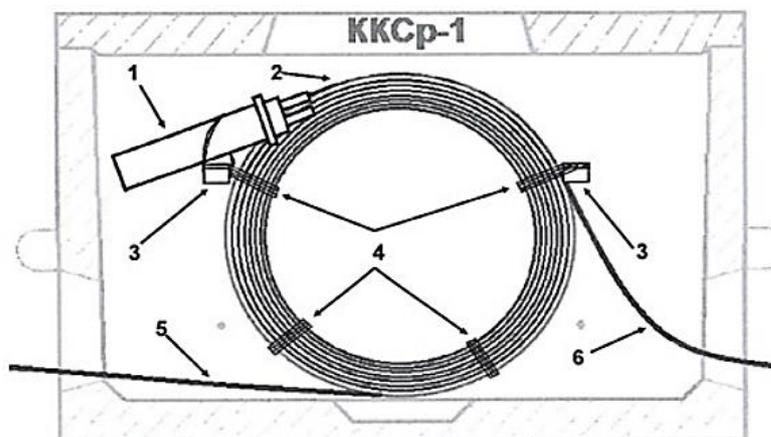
Крепление запаса кабеля и тупиковой оптической муфты на стене железобетонного колодца ККСр-1 с консолями КСО-1:
